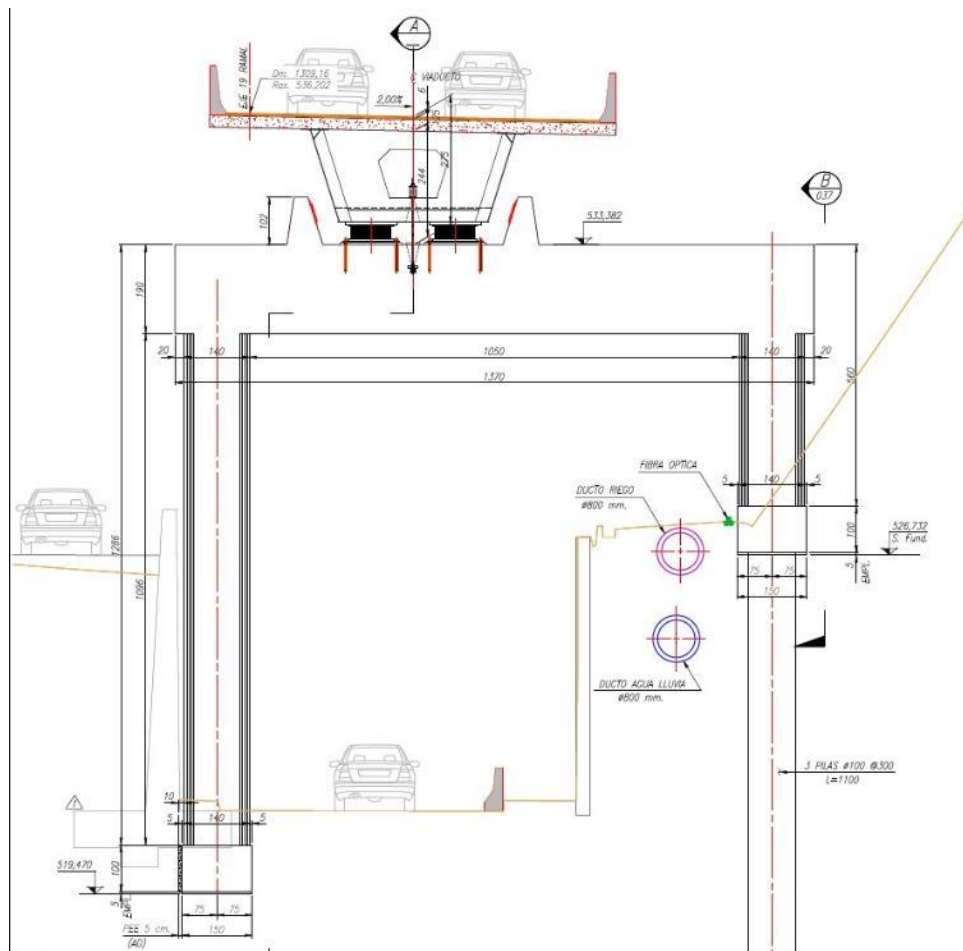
29 Columna Corta Pórtico 29 (Astaburuaga,2020).
